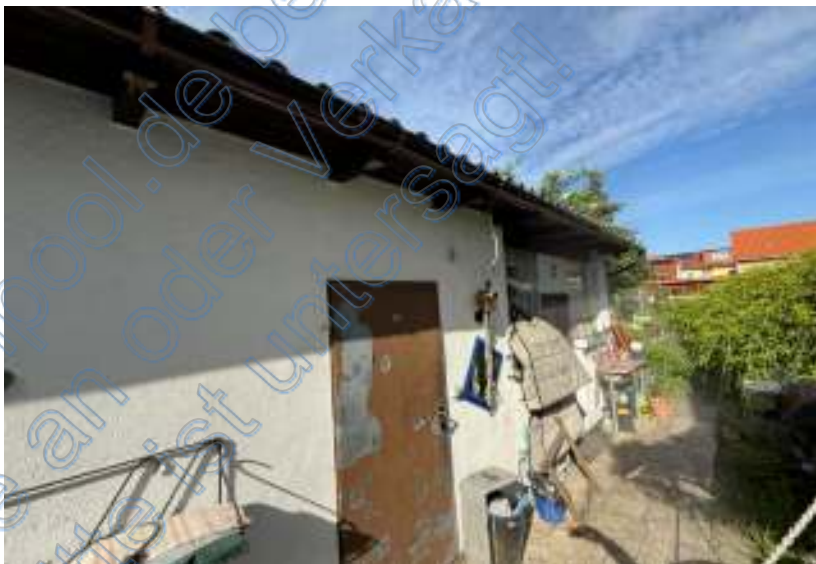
des SV: Nebengebäude (Garage/Werkstatt)
